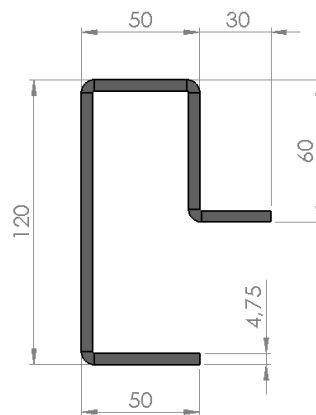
Dimensiones de la sección del perfil plegado para el larguero.
